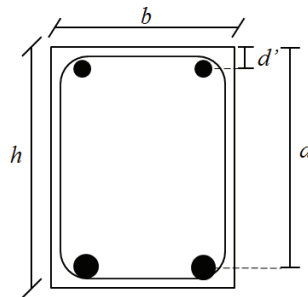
Détails des appellations géométriques en section centrale de poutre
